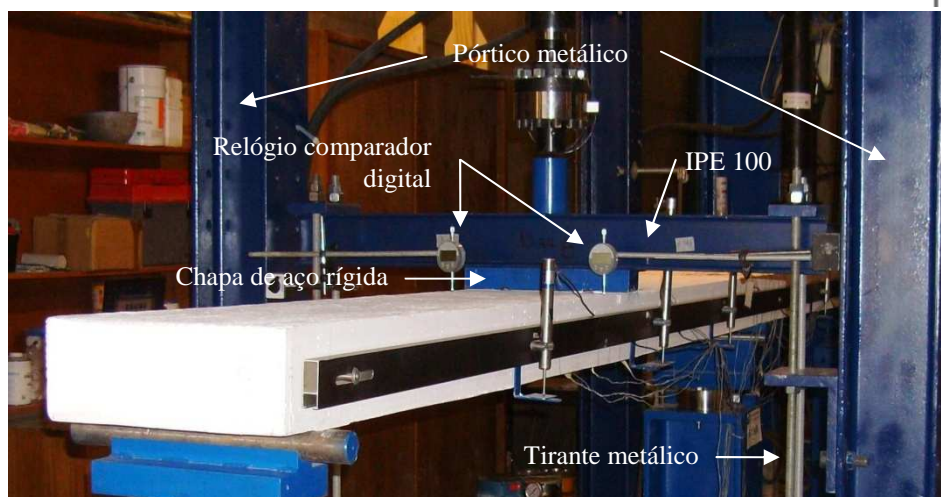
Detalhes do sistema utilizado para sustentar e controlar o deslocamento vertical na região de aplicação da força das faixas de laje do grupo HS a serem reforçadas.
